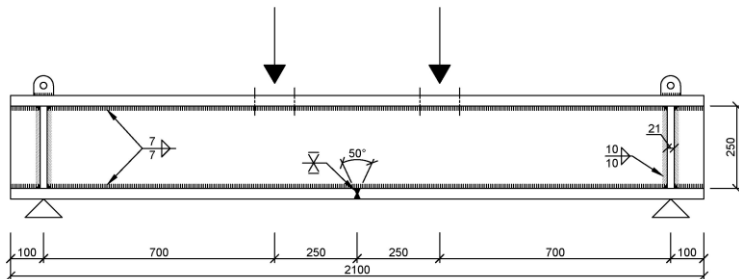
Versuchsträger als geschweißtes I-Profil mit Stumpfstoß im unteren Flansch [116]
